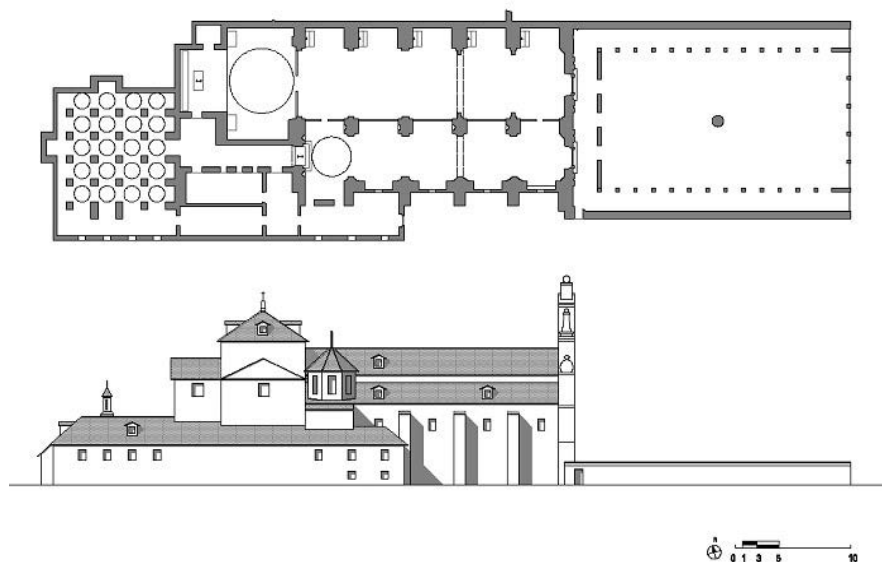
Reconstrucción de la planta y alzado del convento de *Nuestra Señora de Atocha*, a partir de la planimetría de Juan Gómez de Mora (1612) y Manuel de la Peña y Padura (1816).
